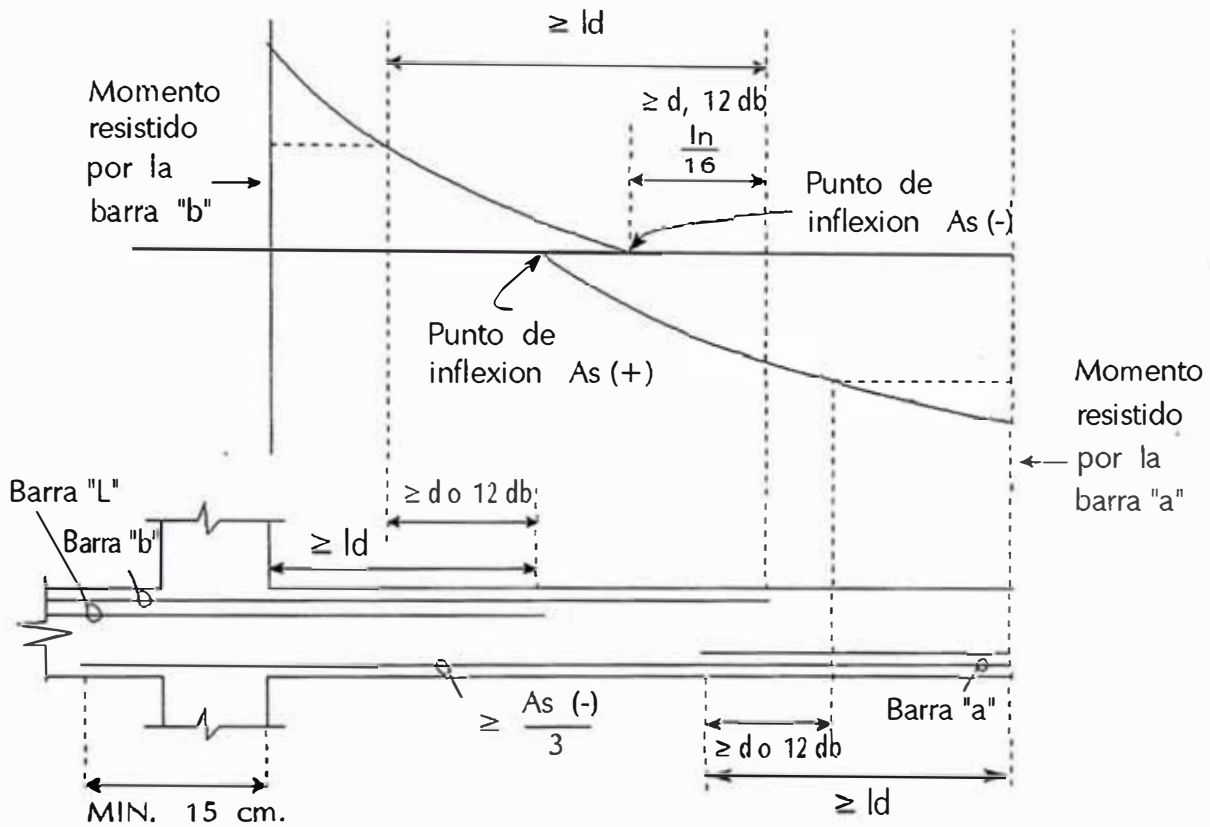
Detalles para refuerzo transversal de elementos en flexión
